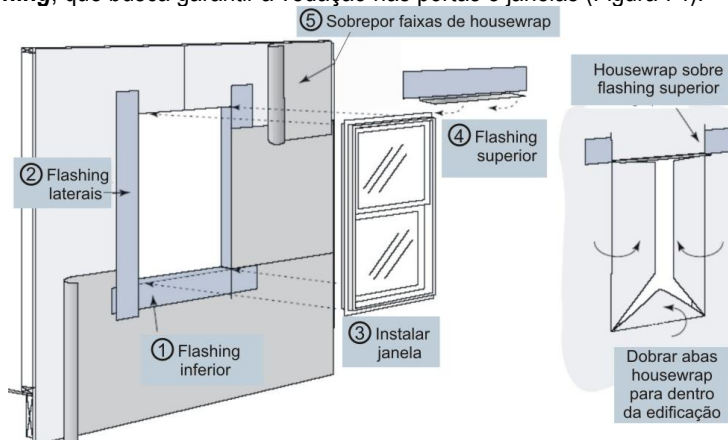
Vedação do entorno das aberturas é garantida pela execução do flashing junto à manta de impermeabilização. Fonte: OFFICE OF BUILDING TECHNOLOGY, 2000.
